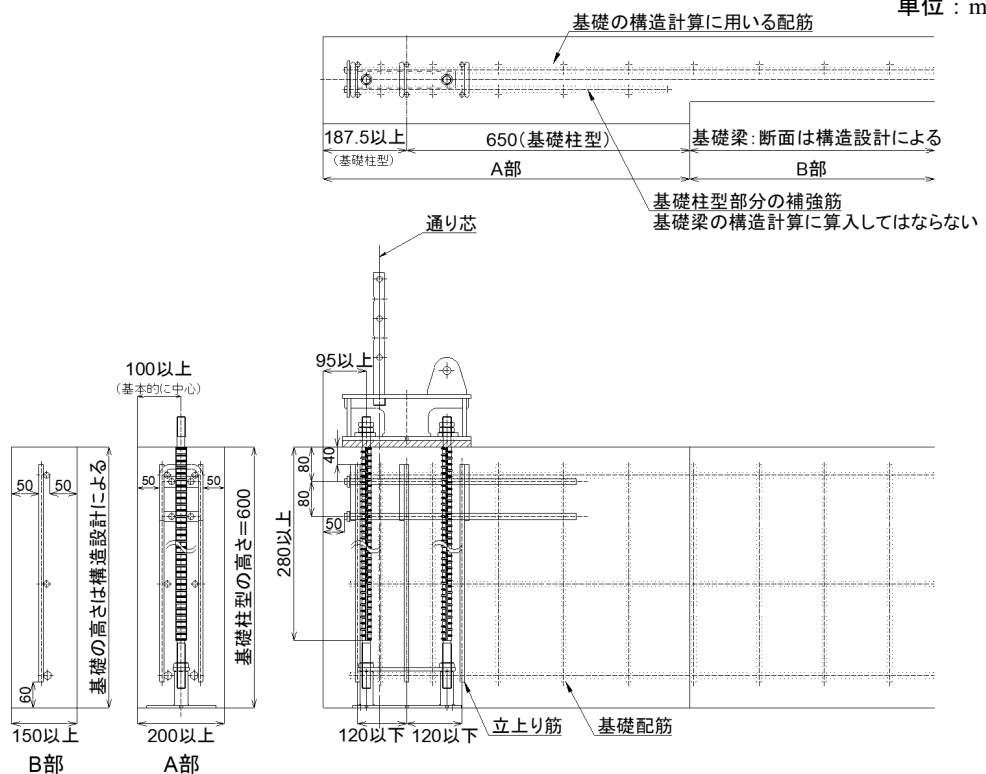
基礎柱型配筋例 (隅柱 シングル型の計画例)
